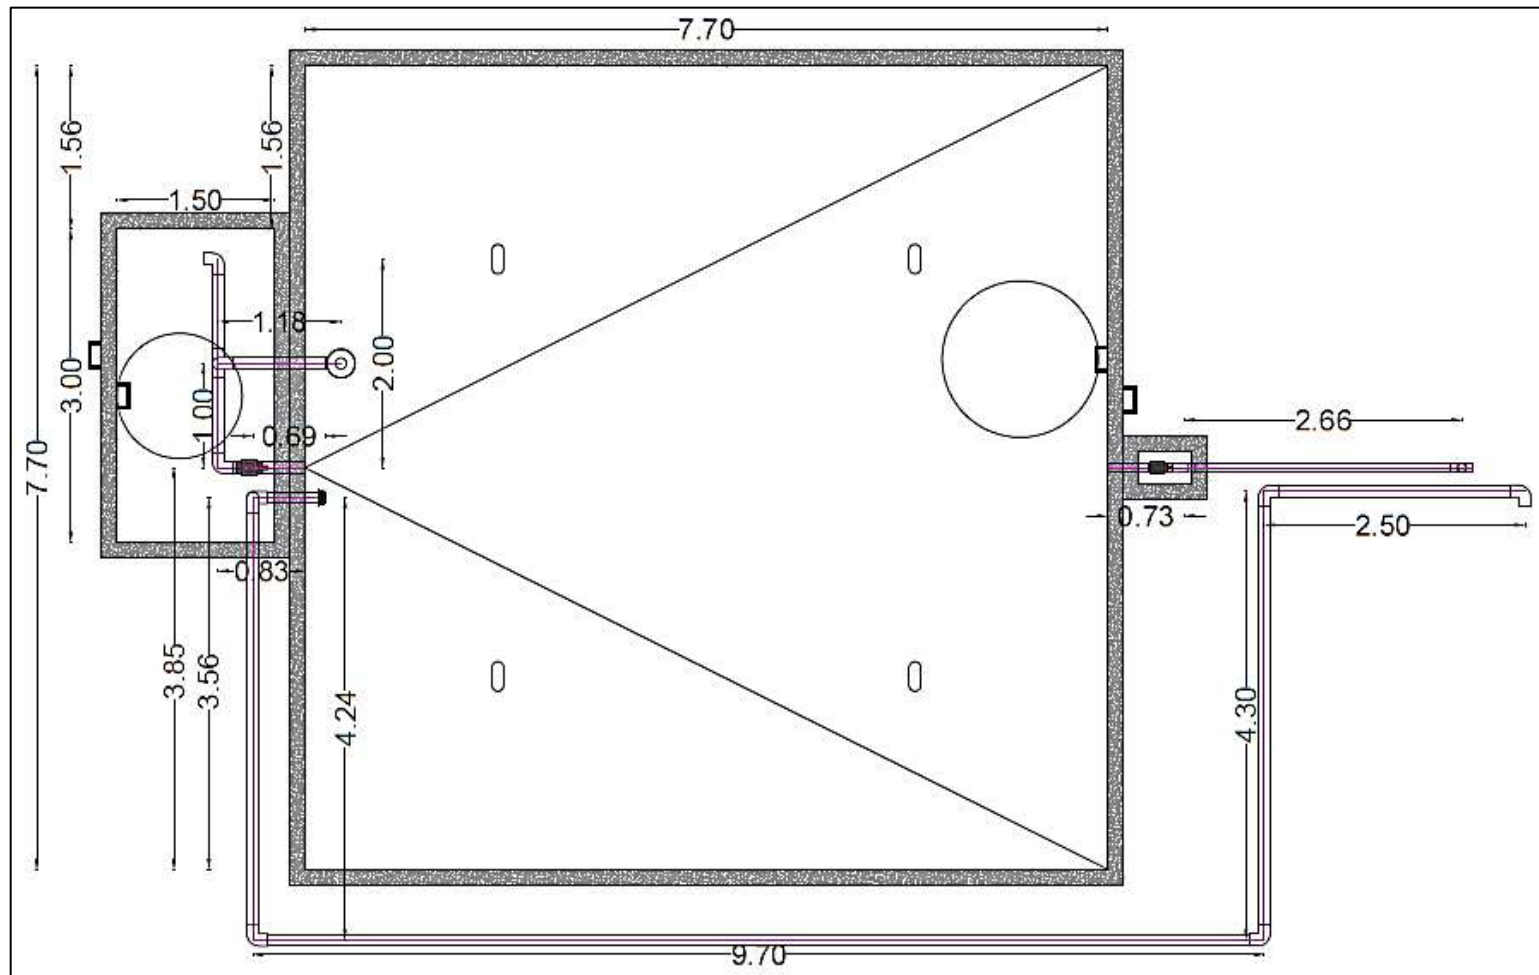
Vista en planta del tanque de succión. Fuente: Elaboración propia.
